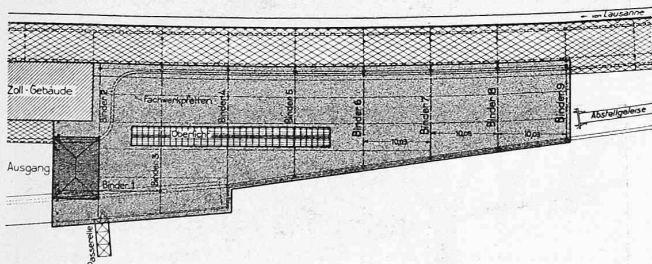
Grundriss des Perrondaches am Bahnhof Genf. — 1:1000.
